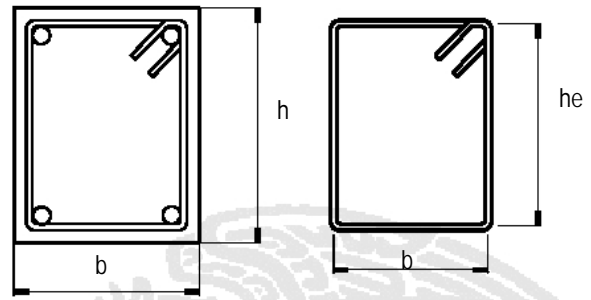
Tolerancias para refuerzo transversal de trabes, vigas y columnas
